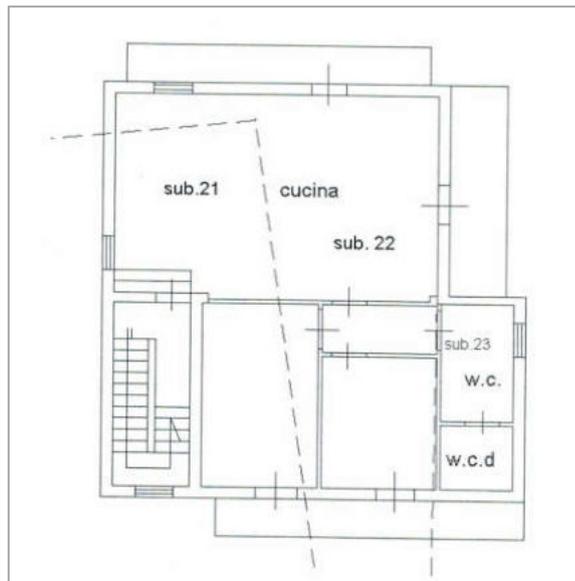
Planimetria catastale p.la 336 sub 21, sub22 e sub 23 graffate
